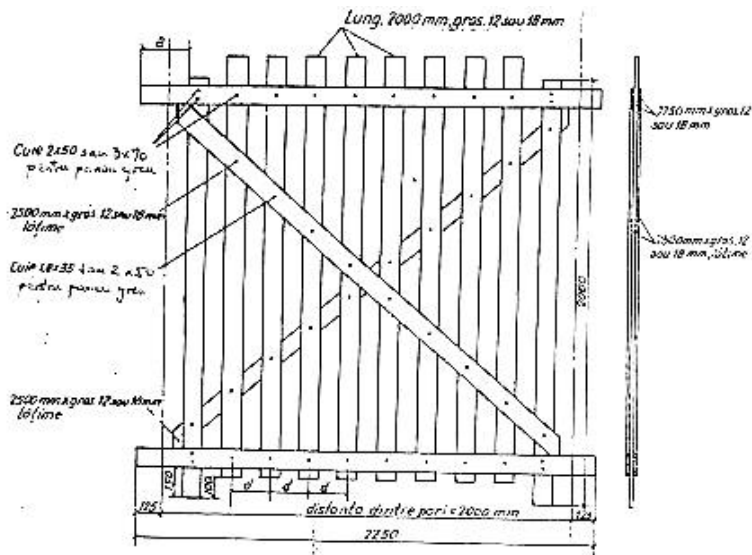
Panoul mobil de parazăpezi din lemn.
